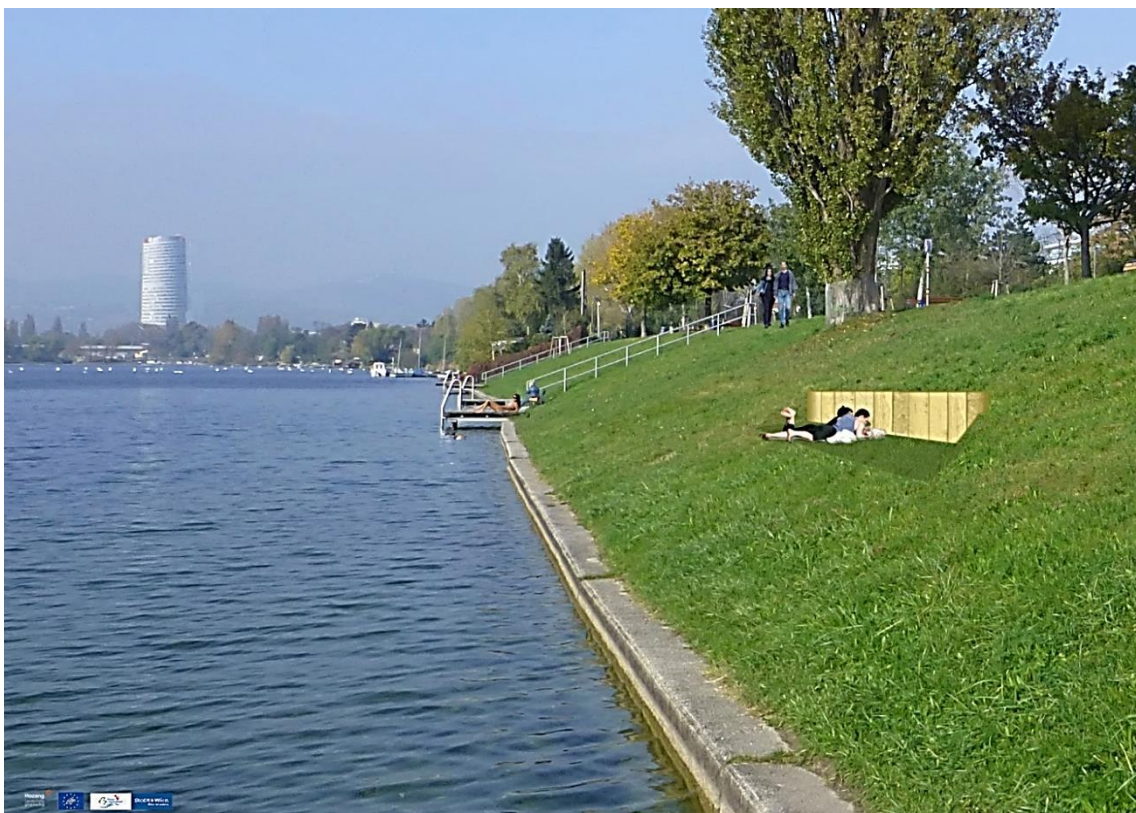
Wiesenterrasse mit Holzschlachtwand und seitlichen Böschungswinkeln, Vorteil – kostengünstiger Bautyp
